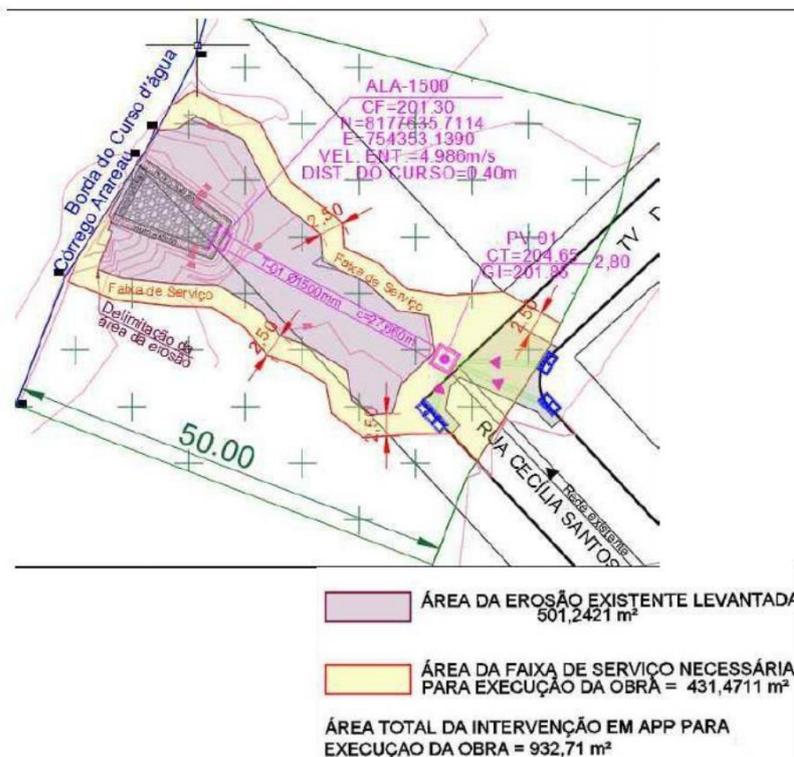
Áreas de supressão de vegetação demonstrada na planta de intervenção apresentada
